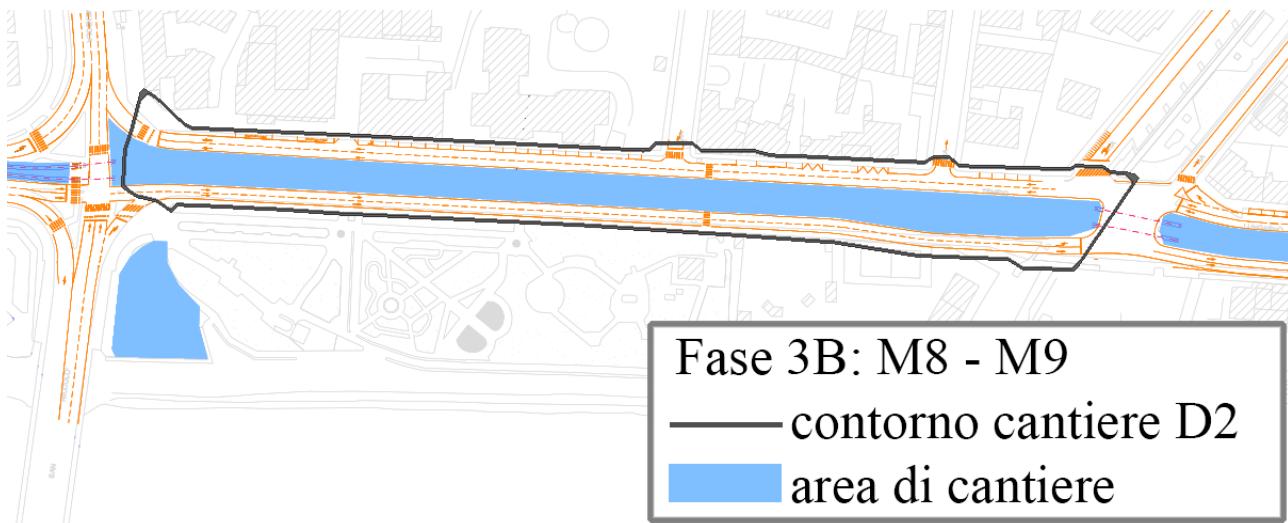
Fase 3B del cantiere D2 - viabilità ai lati dell'area di cantiere con due corsie per senso di marcia - cantiere centrale
